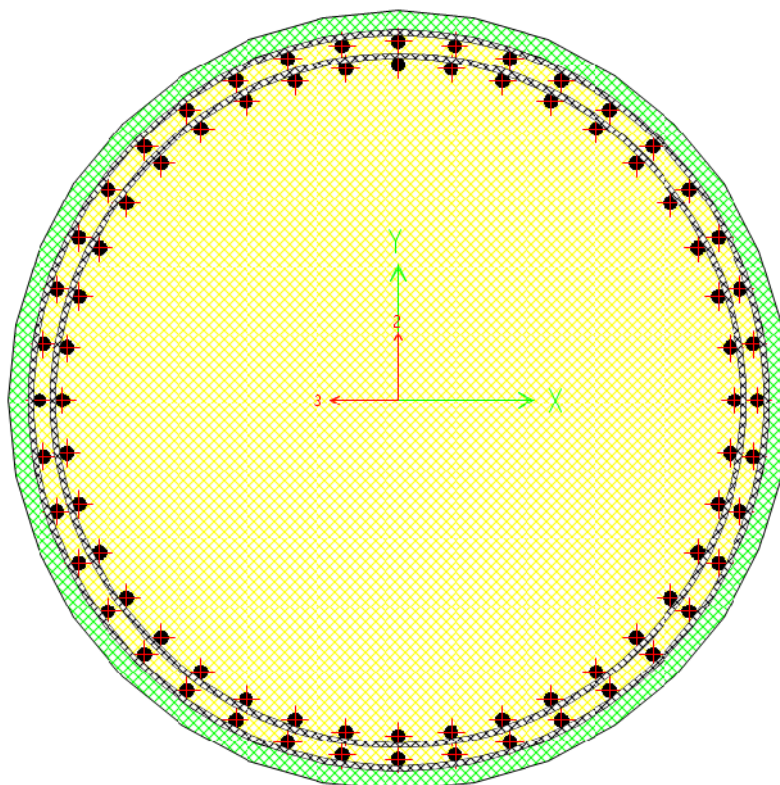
Columna del pilar 2 (Fuente: elaboración propia)
